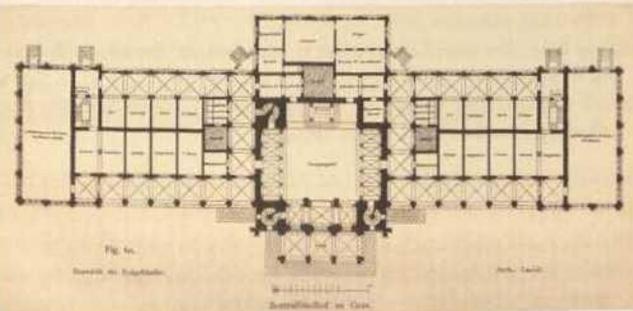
Zentralfriedhof zu Graz, Grundriss
